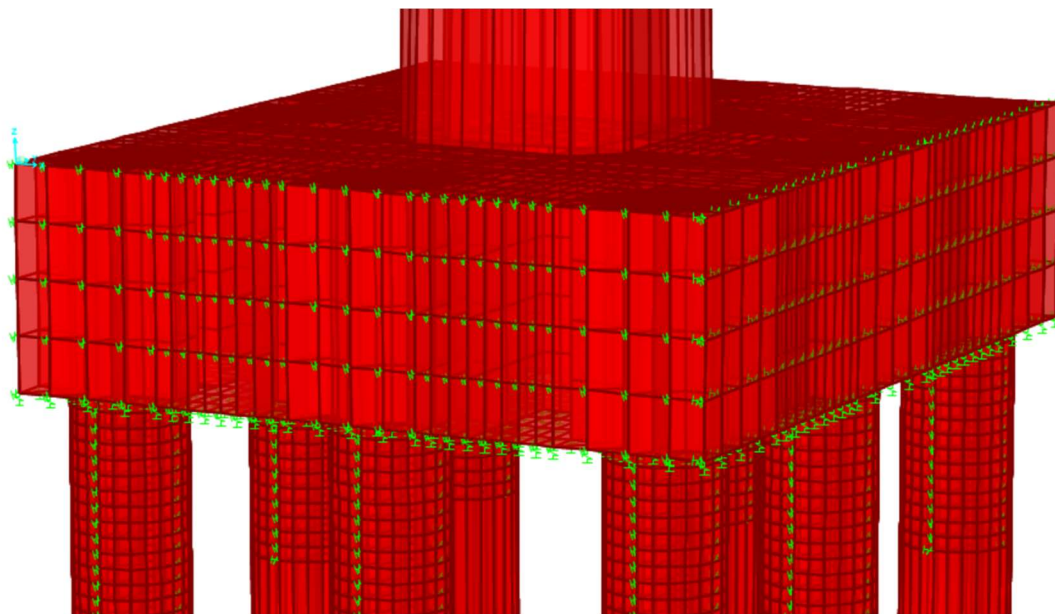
Modelado de la zapata y pilas con elementos sólidos, se aprecian los resortes que simulan el suelo
